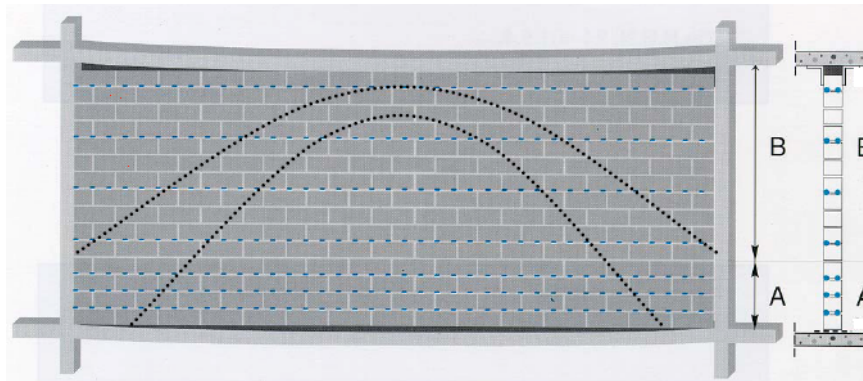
Soluções para evitar fissuras nas alvenarias de vedação associadas à deformação excessiva das vigas ou lajes: separação entre a parede e elementos estruturais superior e inferior, assim como, colocação de armaduras (LOURENÇO, 2002).
